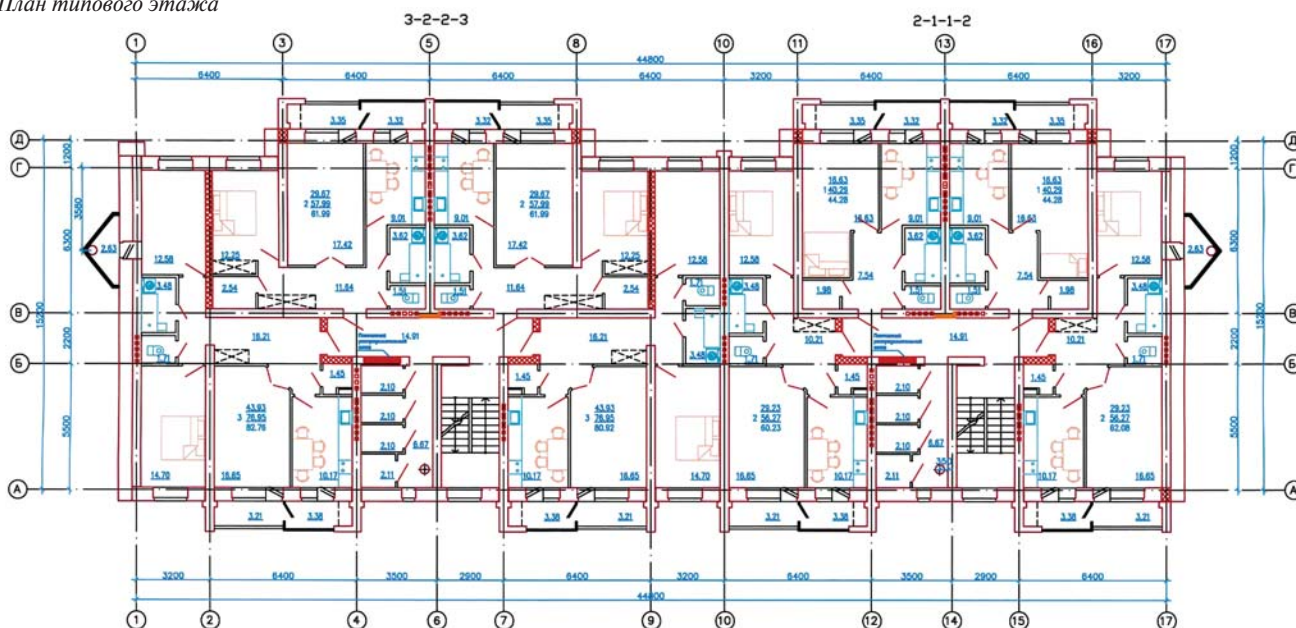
Экспериментальный пятиэтажный 40-квартирный жилой дом с внутренними несущими стенами из кирпича и наружными стеновыми панелями из газосиликата
